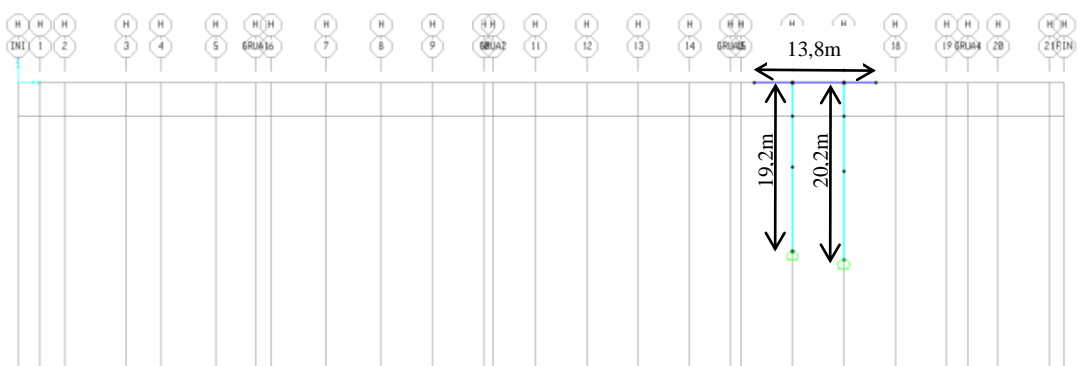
Vista en elevación del plano H de geometría, paralelo a plano X-Vertical'.
